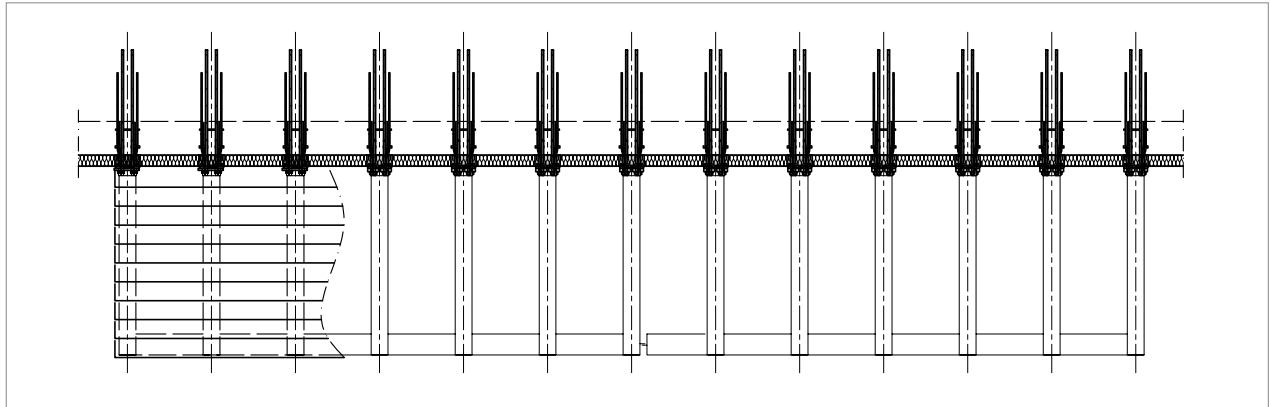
Schöck Isokorb® T type SK : Balcon en porte-à-faux
